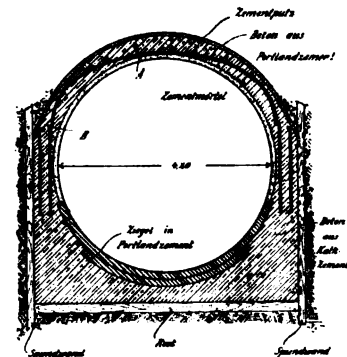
Kanal in der Gilbertstraße in Cleveland, Nord-Amerika 1 : 150.
